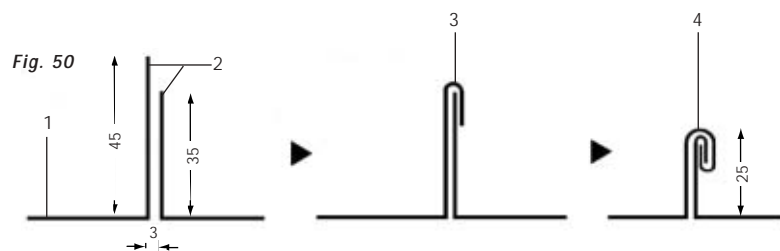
Detalhe construtivo seqüencial de junta longitudinal elevada encaixada.
